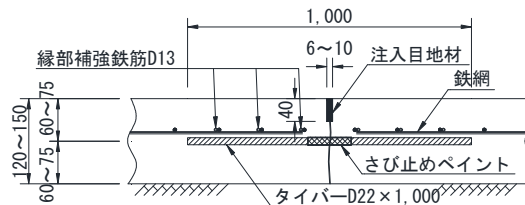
ダミー目地とする縦目地の構造例 (単位: mm) ¹⁾
